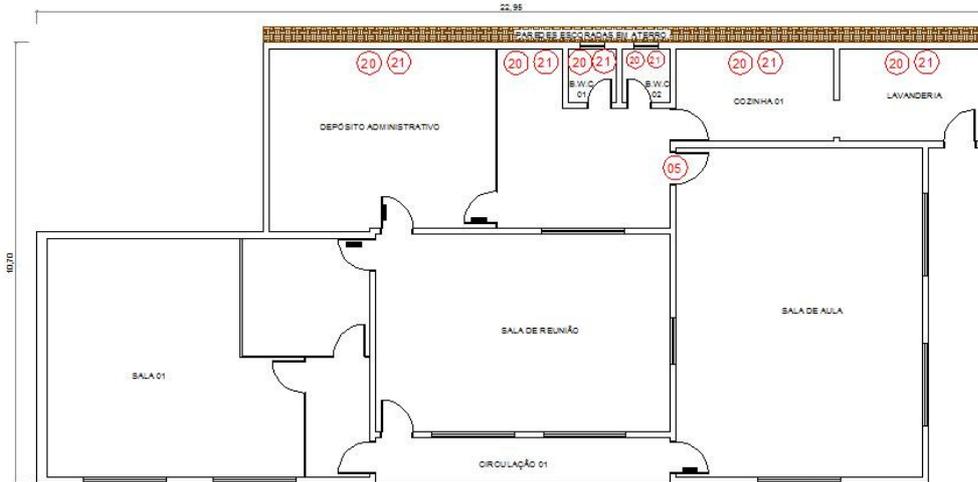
Planta Baixa Térreo Favinho de Mel – 1 de Maio
